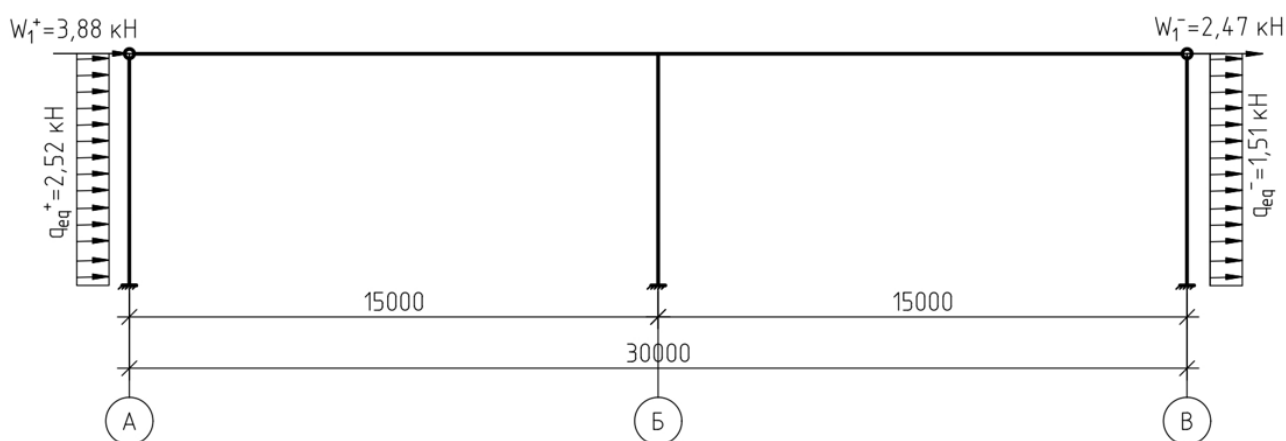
Загрузка поперечной рамы здания ветровой нагрузкой
